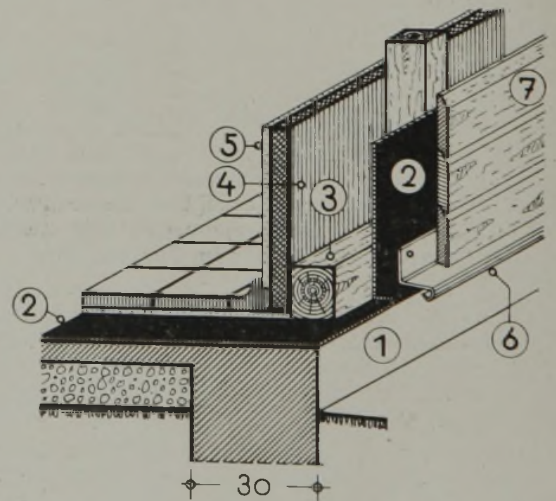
Holzfachwerk, innenseitig mit Holz-wollplatten isoliert.
